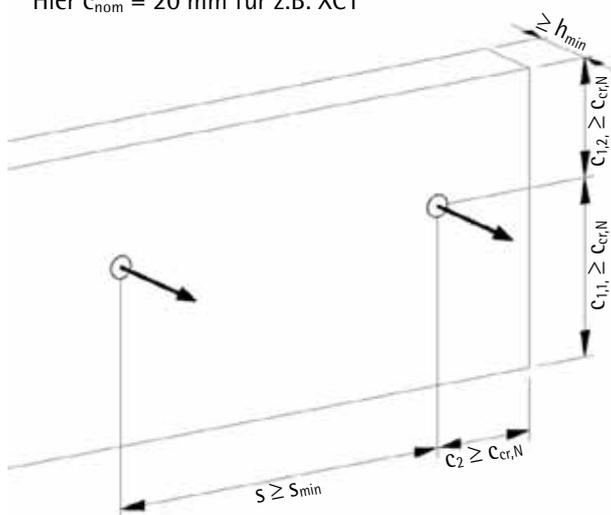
Einbausituation Wandfläche - Zugbeanspruchung
